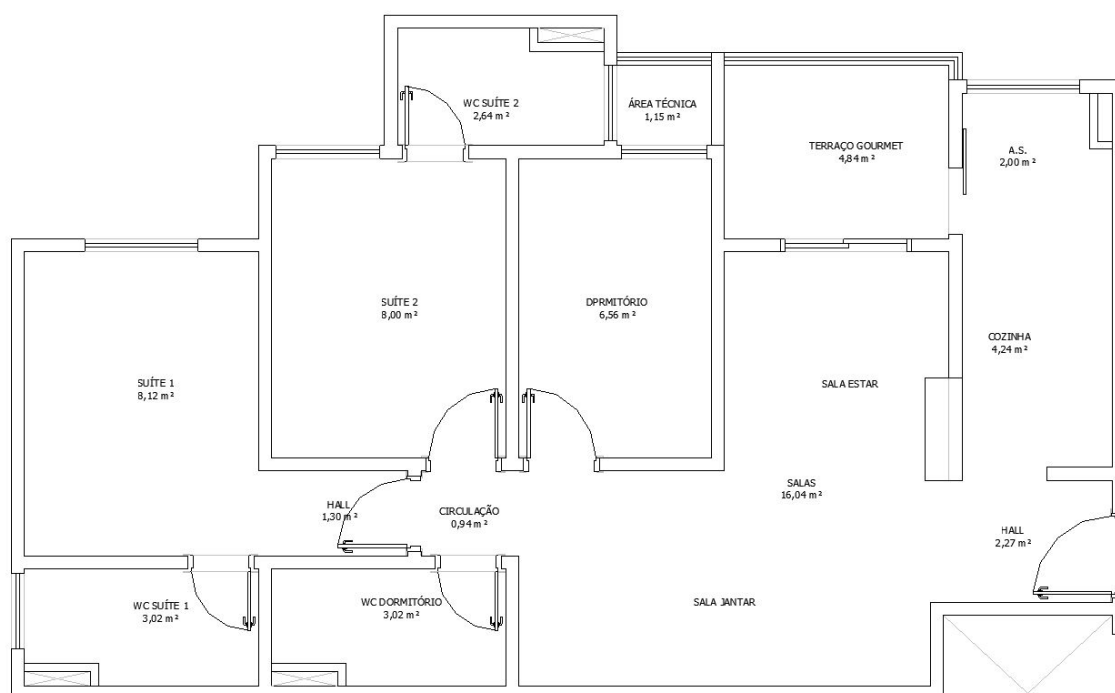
Blocos 2 e 4 – planta apartamento 2 dormitórios e 1 suite.
